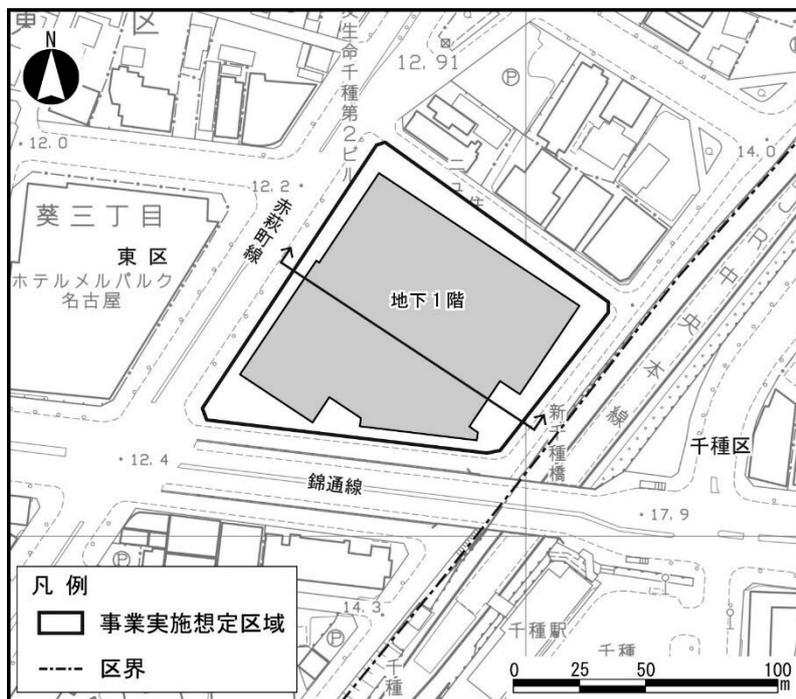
(2) 地下1階平面図及び断面図 (B案)
